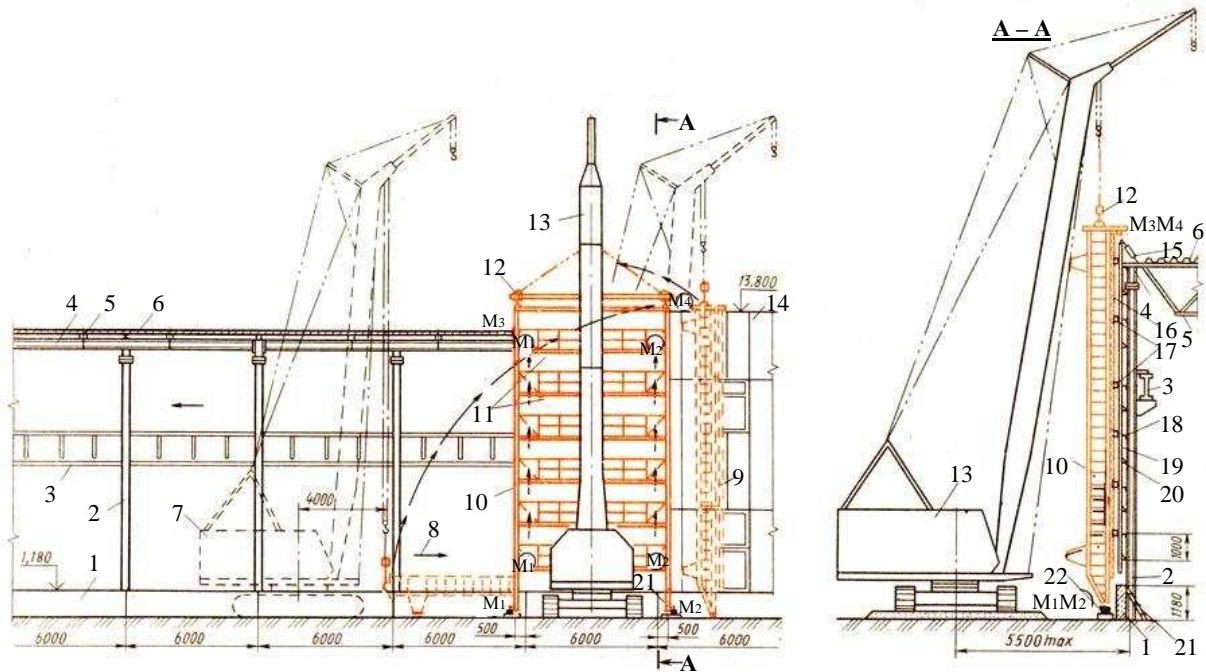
Схема монтажу стінових панелей: 1 – цокольні панелі; 2 – колони; 3 – підкранові балки; 4 – підкрів'яні балки; 5 – крокв'яні ферми; 6 – покриття із профнастилу; 7, 13 – монтажний кран; 8 – напрям руху крана; 9 – збірно-монтажний пристрій під час збирання та піднімання стінових панелей; 10 – те саме під час установлення; 11 – майданчики-риштування; 12 – монтажна траверса; 14 – змонтовані панелі; 15 – гвинтова стяжка; 16 – стінова панель; 17 – ригель; 18 – опорні стіл для кріплення ригелів до колони; 19 – драбина навісна; 20 – сходиць відкідний; 21 – драбинка; 22 – домкрат; М<sub>1</sub>–М<sub>4</sub> – робочі місця монтажників
